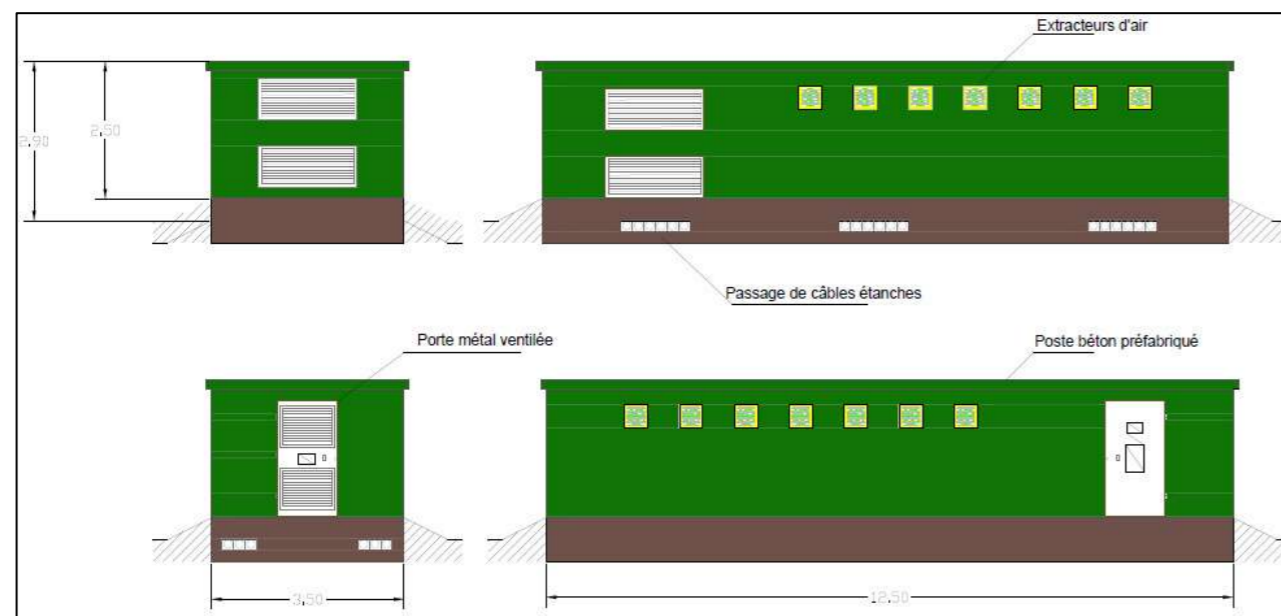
Plan de façade des postes de transformateur/ onduleur
